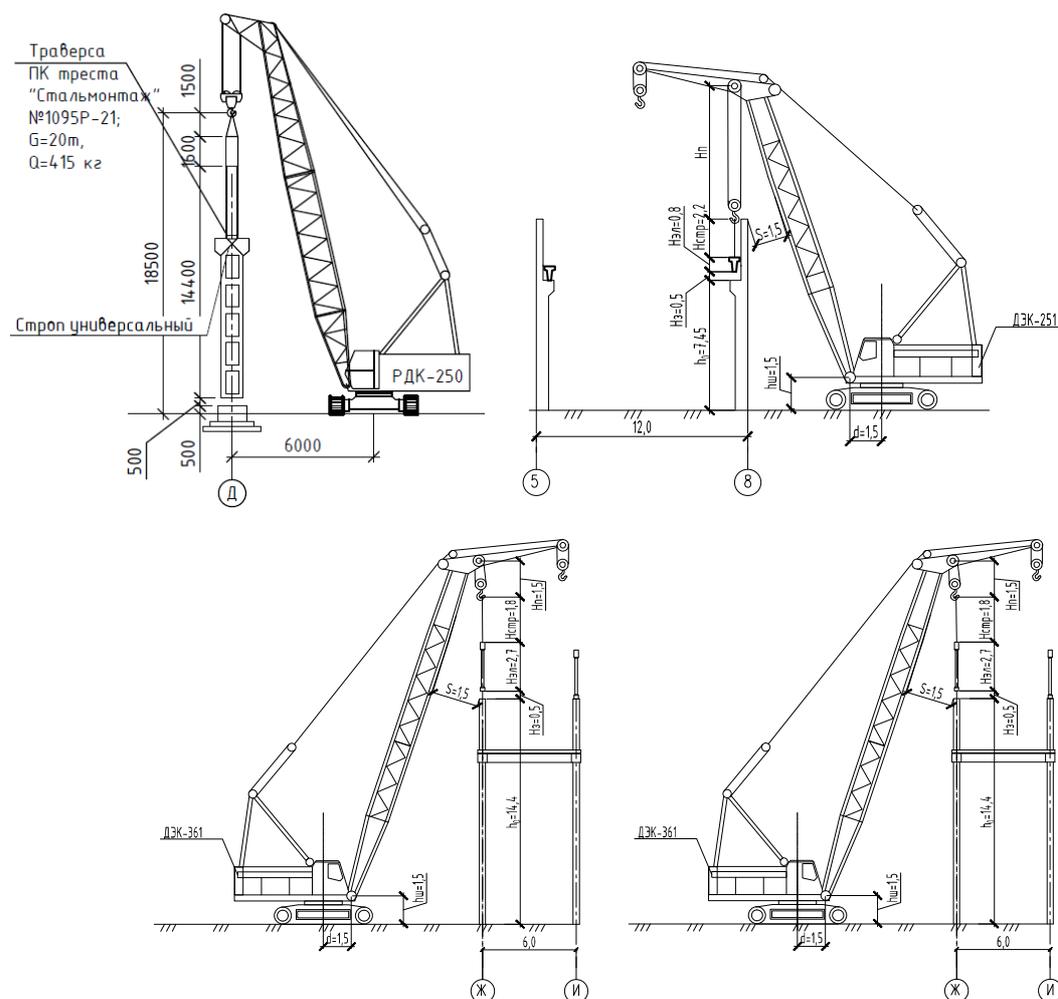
Расчетные схемы монтажа основных железобетонных конструкций каркаса здания (выполнил Королев Е.И.. гр. ТСНК-18)
